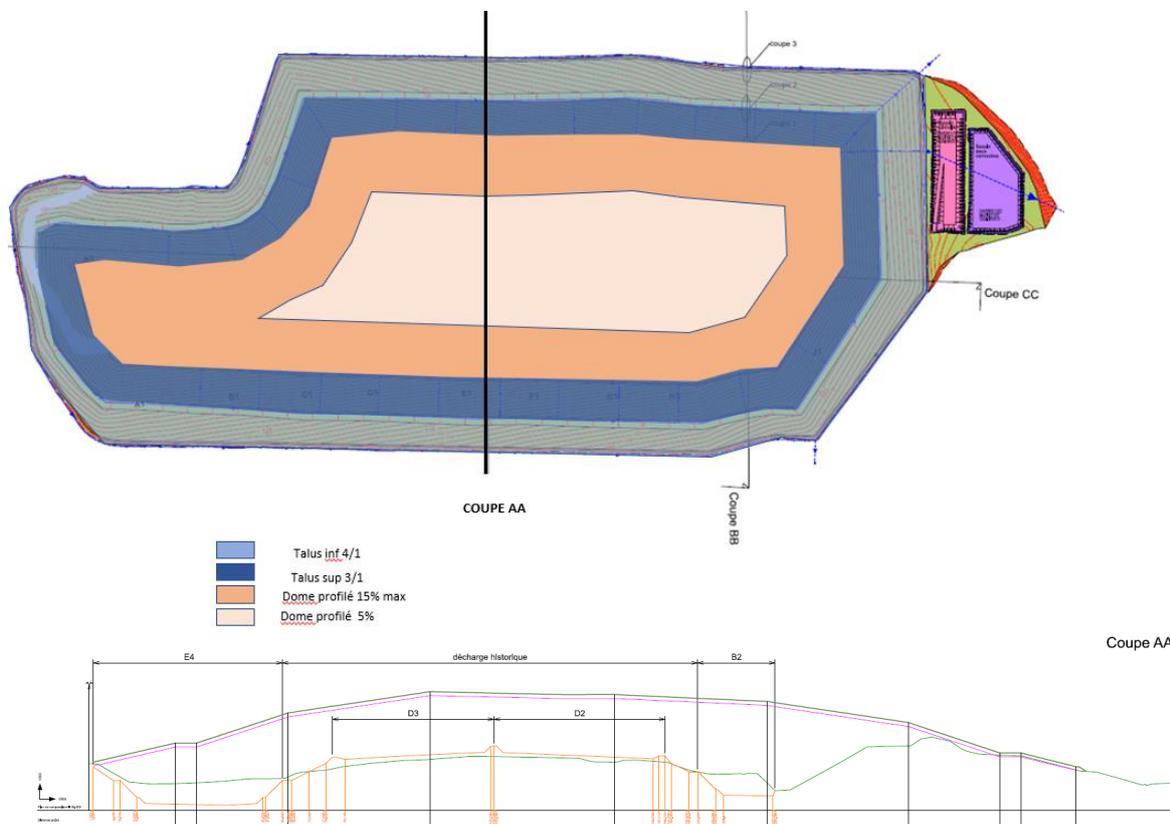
Principe de réaménagement final projeté – Vue en plan et en coupe
